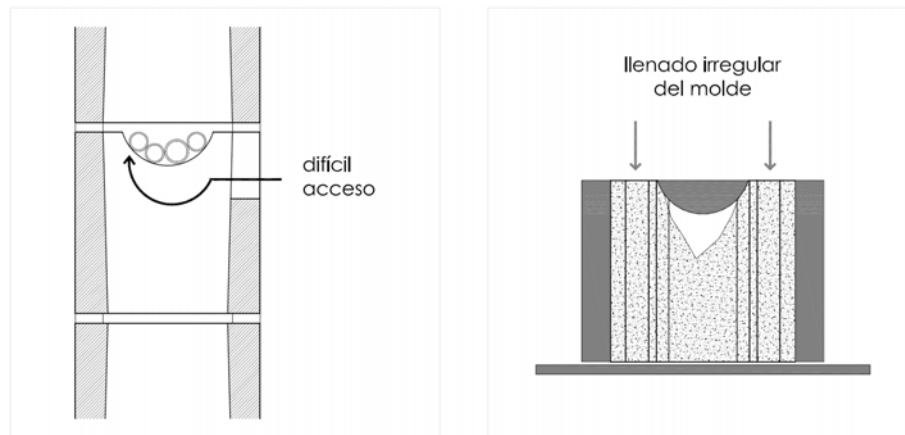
Posible dificultad de acceso al ejecutar la instalación de los mecanismos [izquierda]. Posible llenado irregular del molde [derecha].
